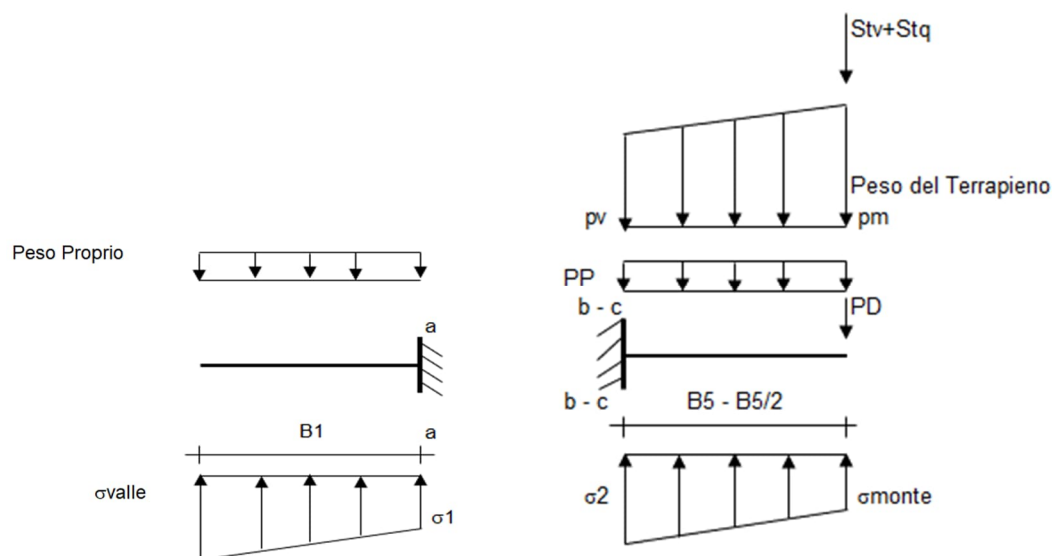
Schemi statici adottati per il calcolo delle sollecitazioni nella fondazione del muro
